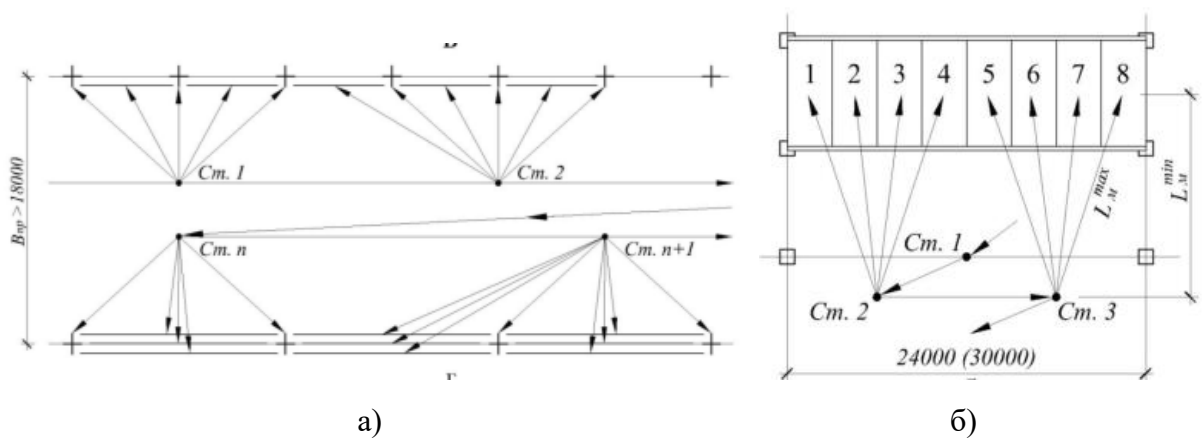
а - Схема проходки крана для монтажу першого комплекту конструкцій; б – схема проходки крана для монтажу другого комплекту конструкцій.
